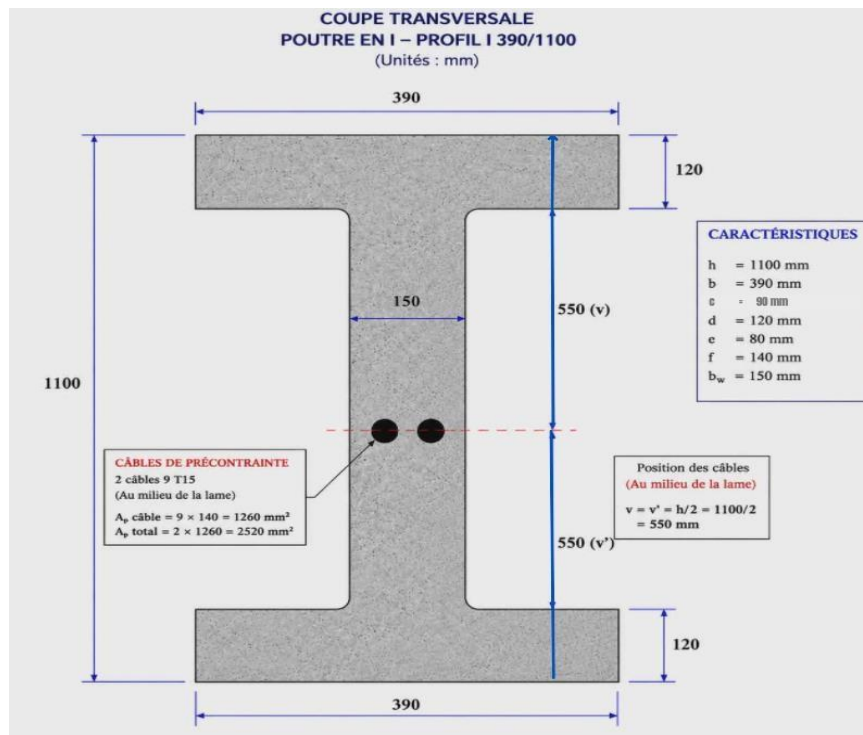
Coupe transversale de la poutre précontrainte.
